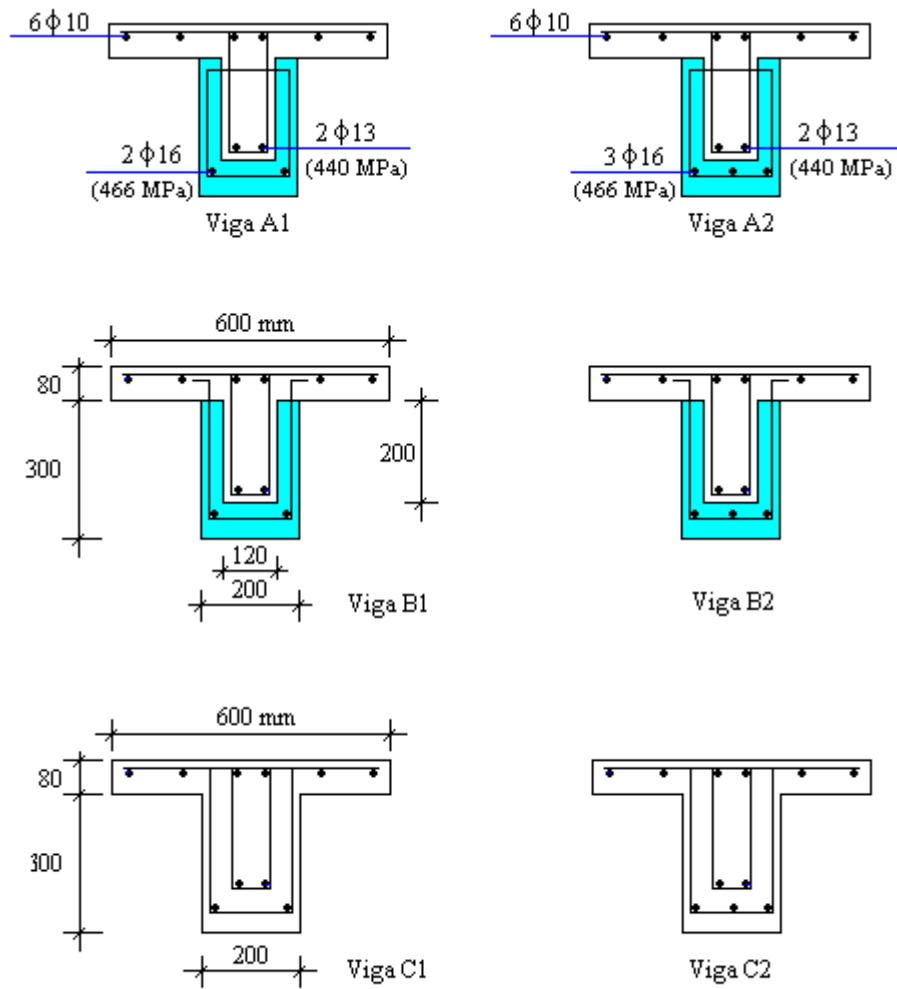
Seção Transversal das Vigas Ensaçadas
